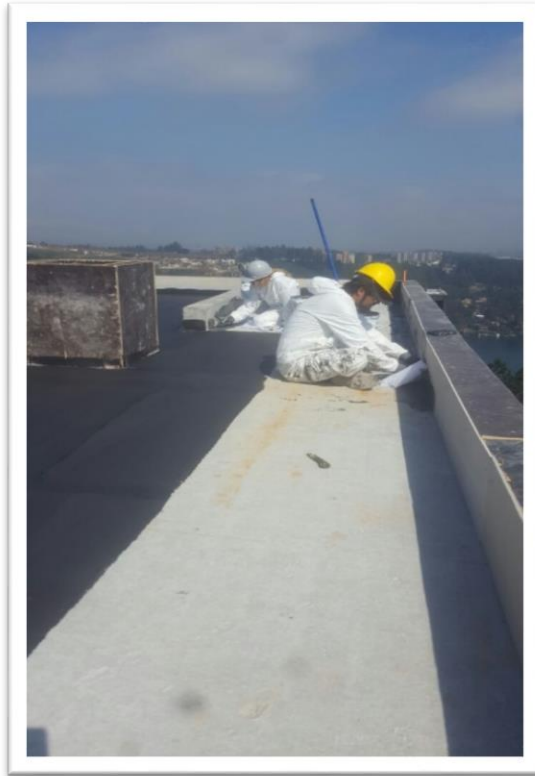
4: Geotextil empleado en Impermeabilización de terrazas.
